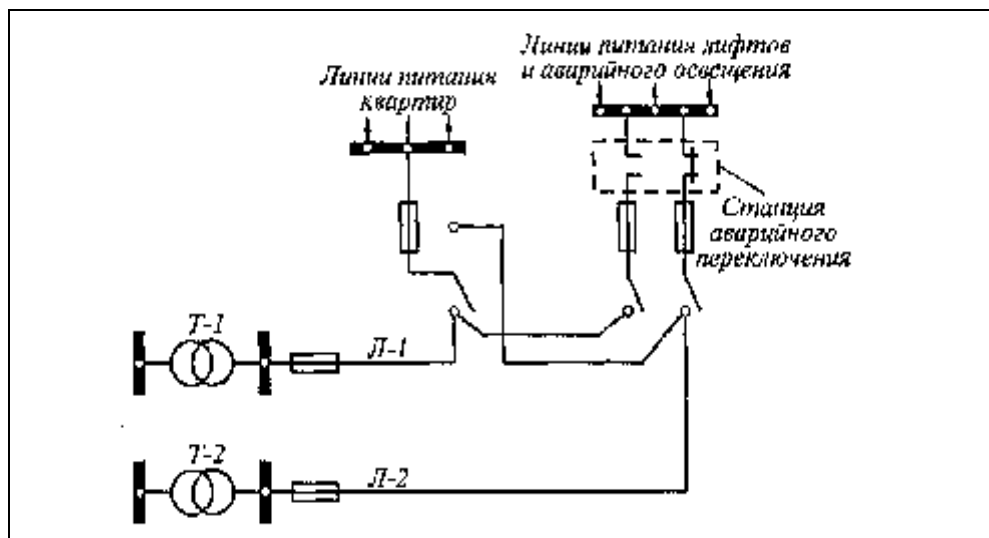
Схема питания напряжением до 1 кВ жилого дома выше 16 этажей.
